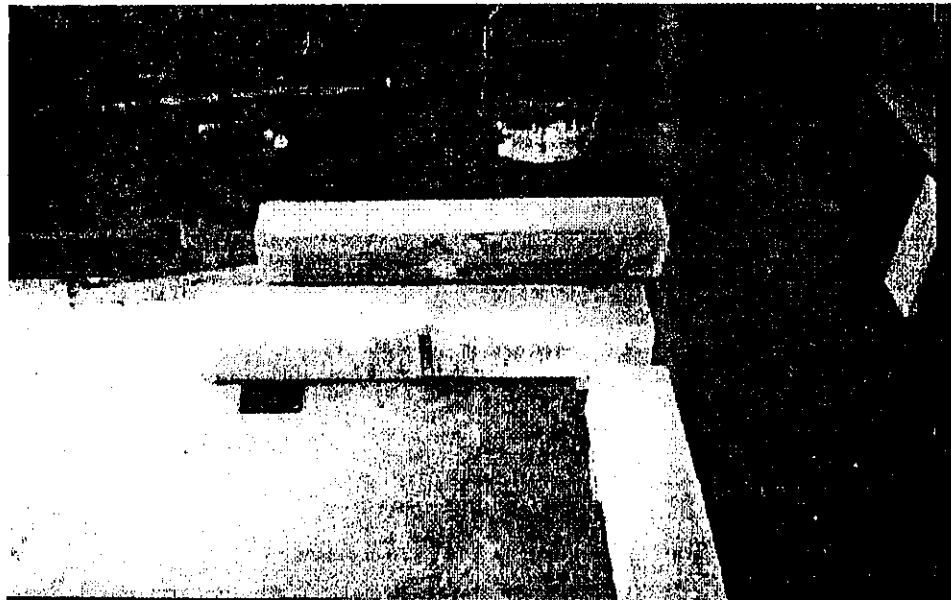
Fabricación de las tres piezas de concreto para realizar el ensayo de tracción.
